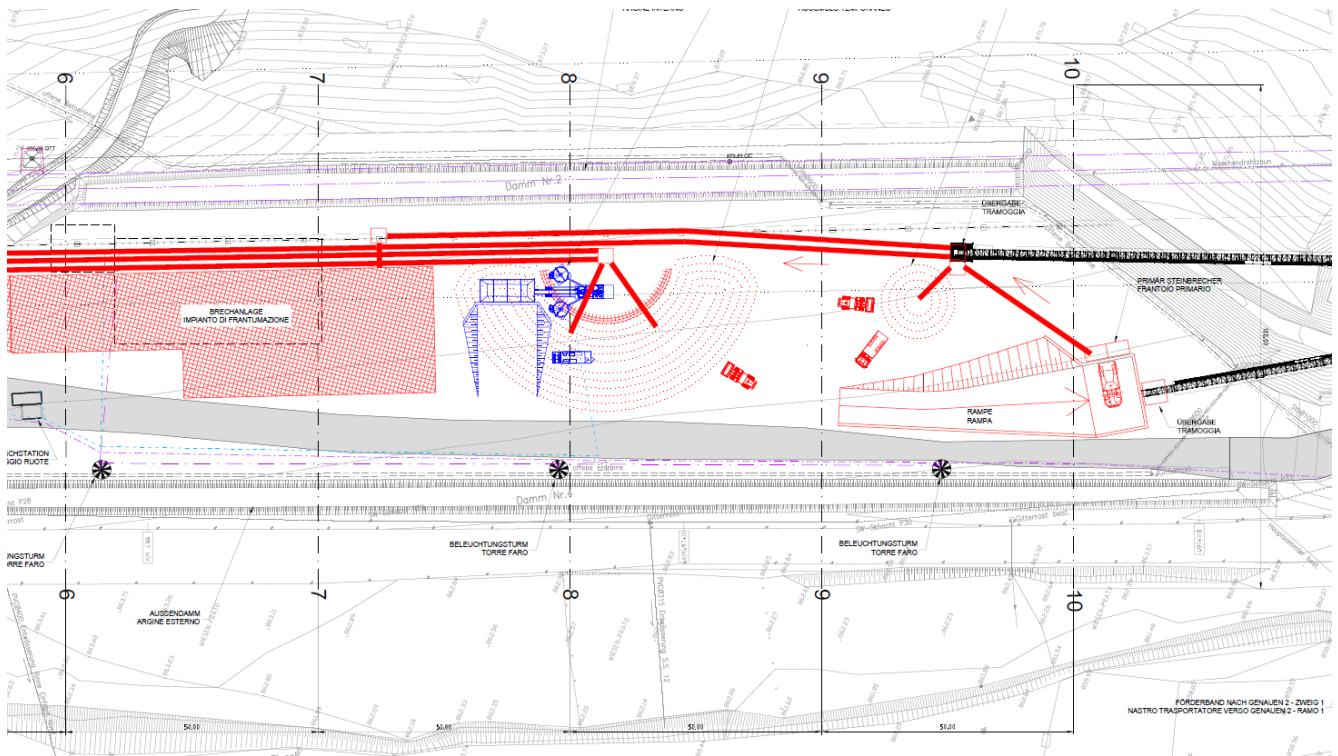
Baustelle Mails: Lageplan Fläche Nr. 1 Süd
